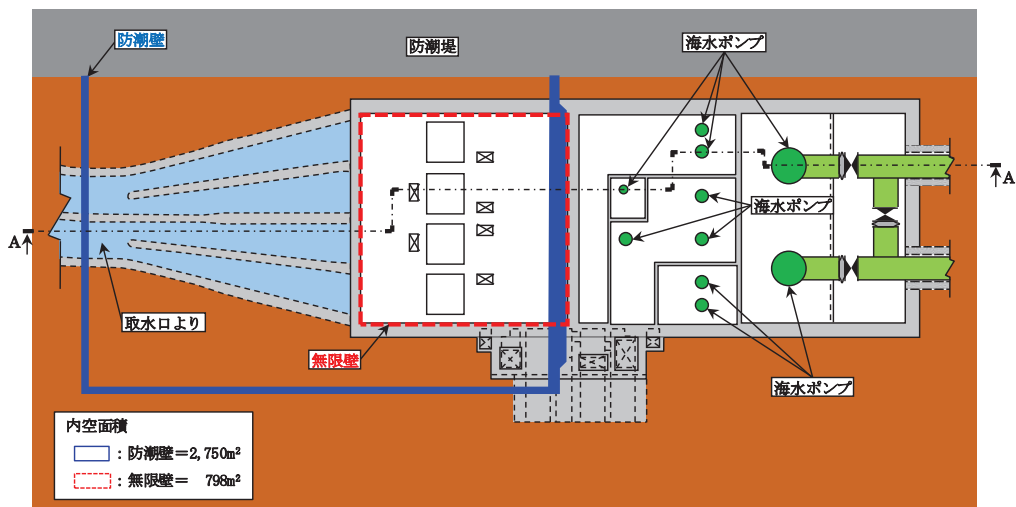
(1) 第 2 号機海水ポンプ室平面図
